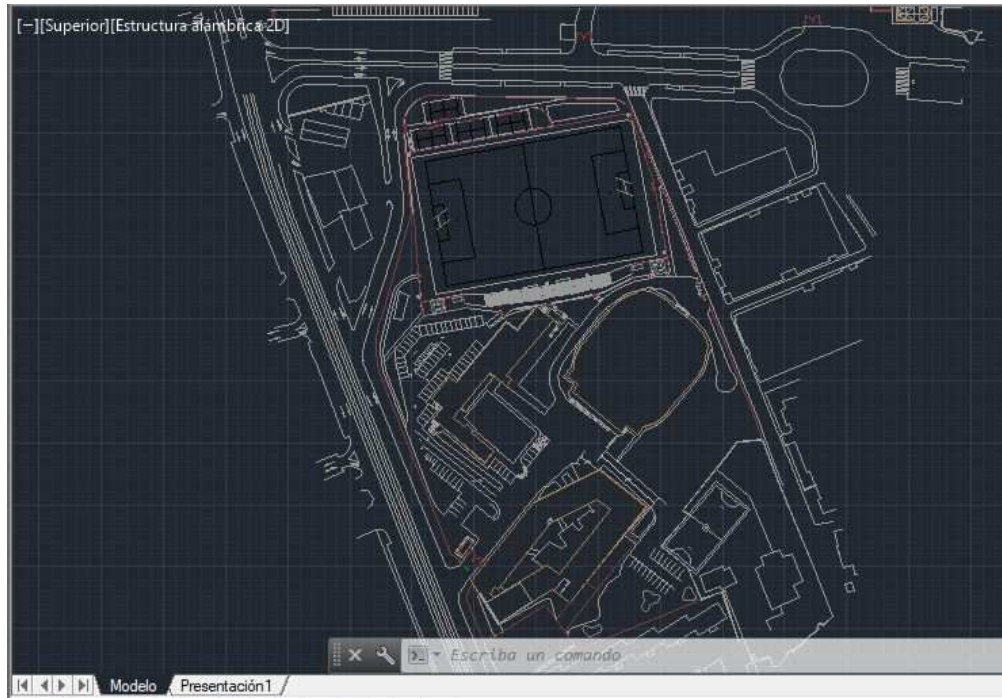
Plano de zona de pabellón e instalaciones deportivas.
